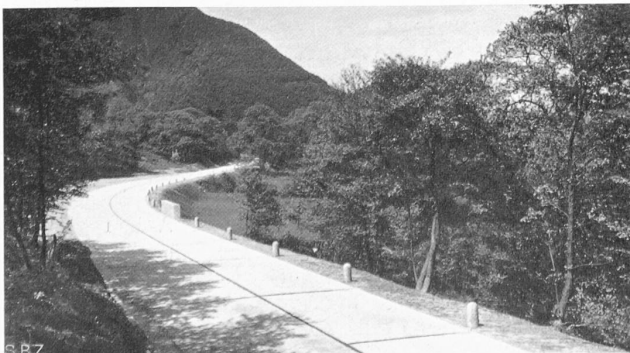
Betonstrasse Ceneri Nordrampe, nahe der Passhöhe.
